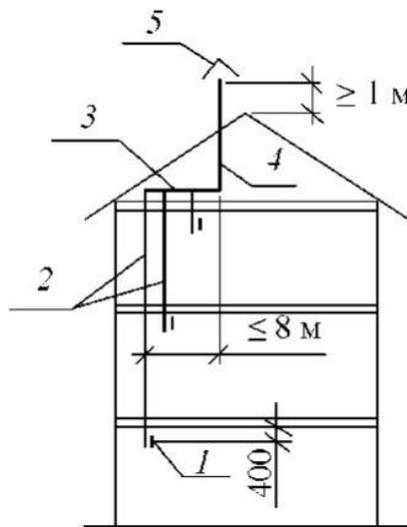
Принципиальная схема естественной вентиляции жилого дома
